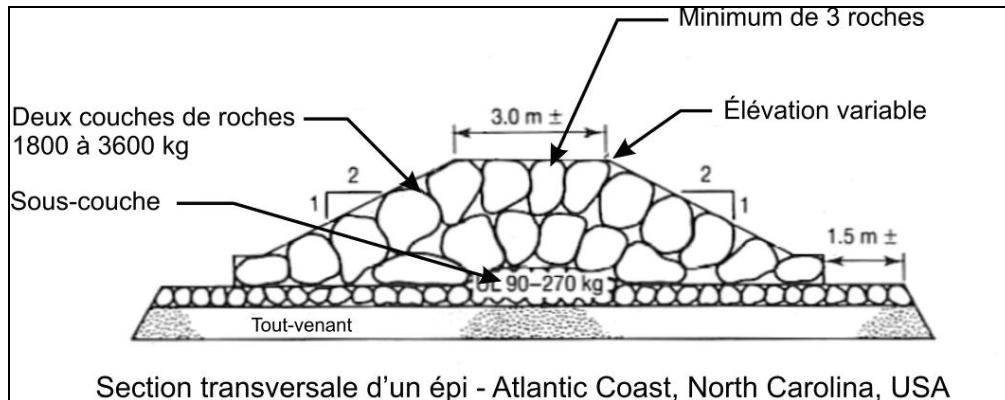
Section transversale d'un épi construit sur la côte atlantique, en Caroline du Nord, USA
